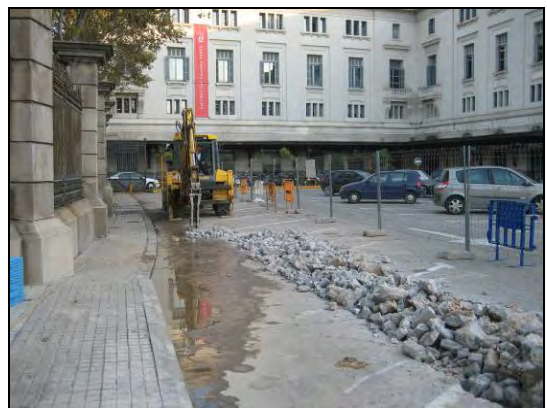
Màquina retroexcavadora picant el paviment per tal d'efectuar el sondeig B2
